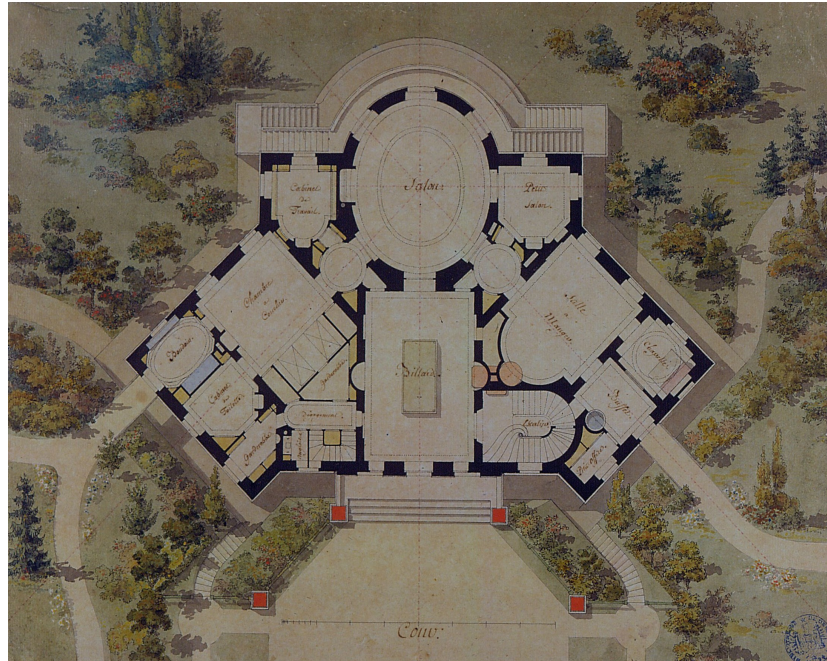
Pierre-Adrien Pâris Plan du rez-de-chaussée du château de Colmoulin BMB vol. 484 n° 60. © BM Besançon
